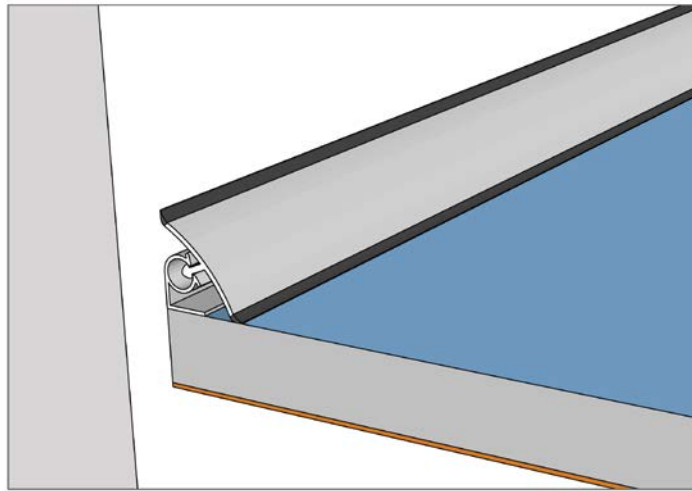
Wandanschluss mit Wandabschlussprofil
